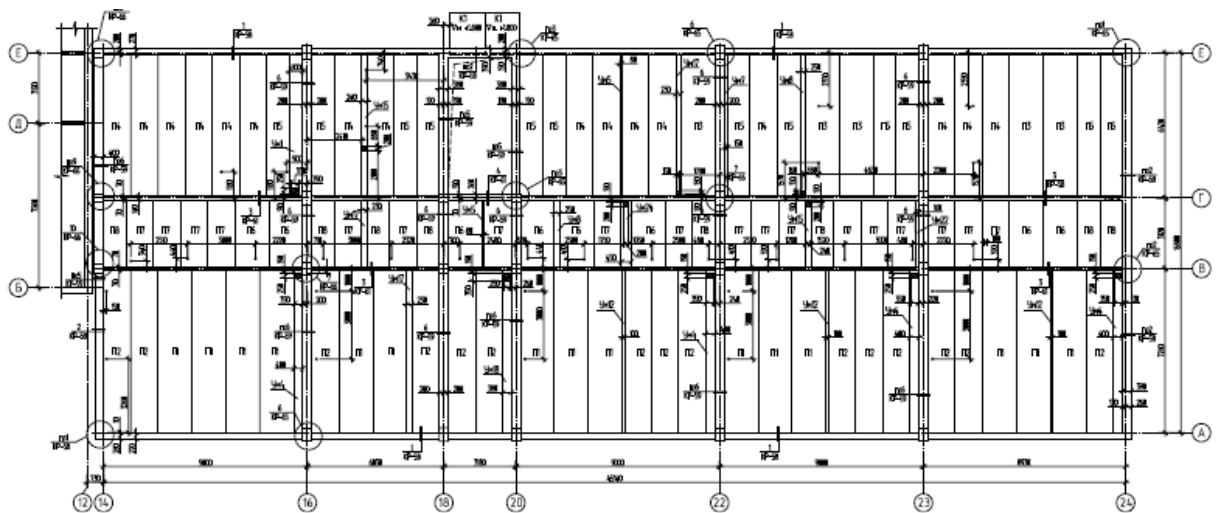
Схема расположения плит перекрытия и антисейсмического пояса на отм. + 3,000 в осях А-Е, 14-24
